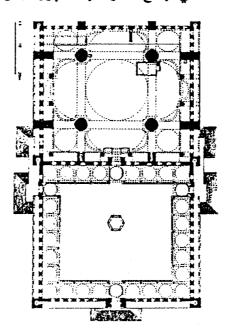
مسقط أفقي لمجمع (كلية) السلطان محمد الفاتح باستانبول. (عن : Goodwin).
